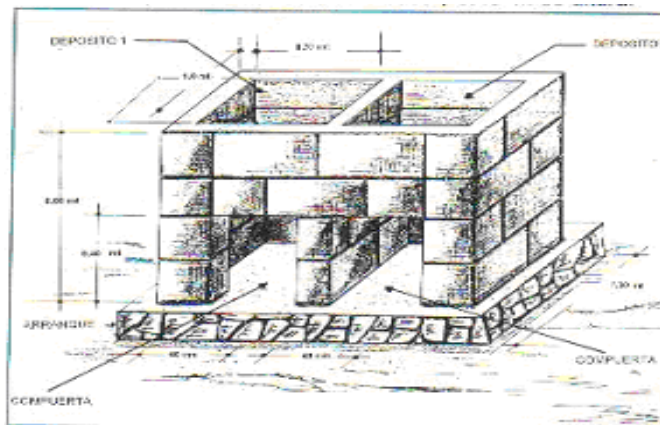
Vista de las compuertas de los depósitos de las LAFS
